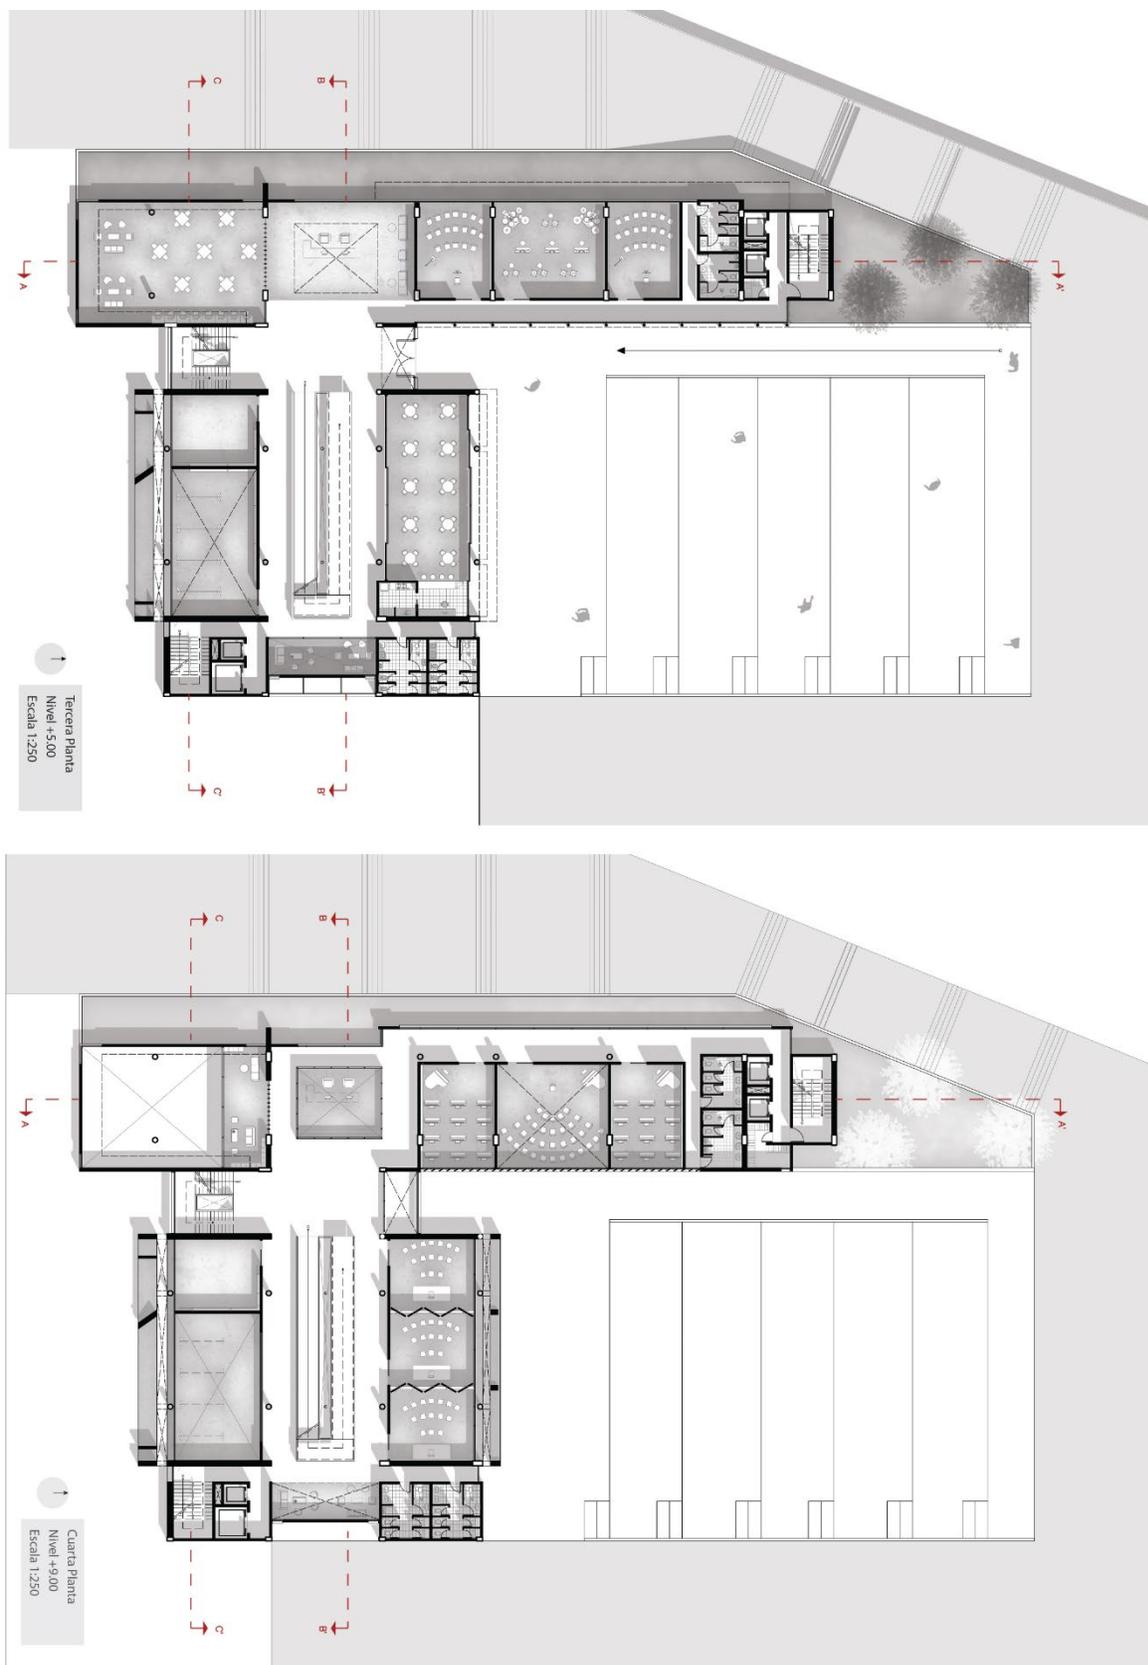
Planta 3 y Planta 4. Elaboración Propia.
